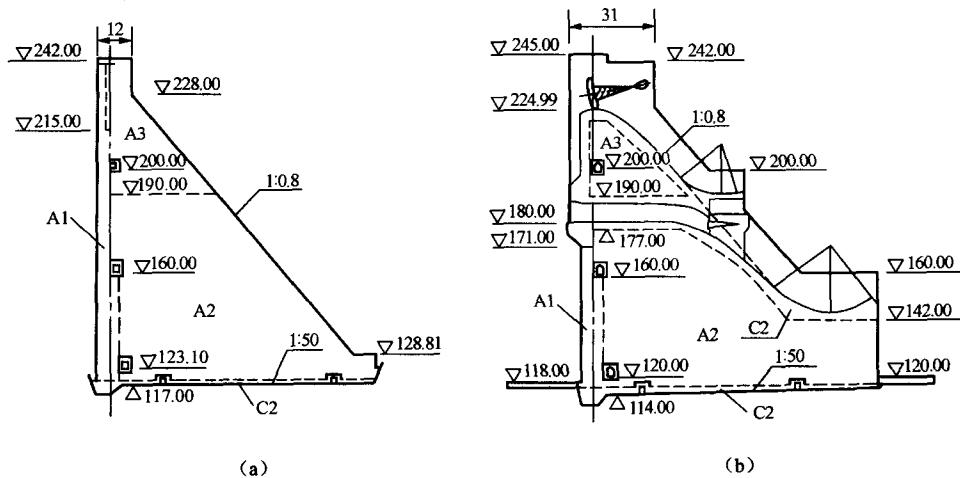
江垭碾压混凝土重力坝剖面图（单位：m）
